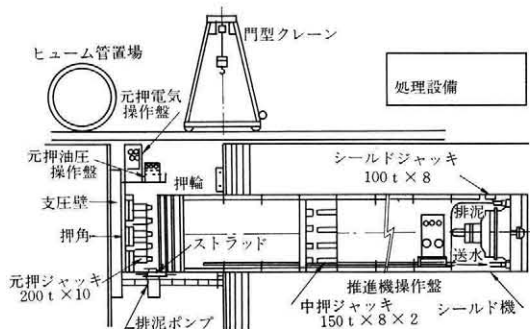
I D3,000 × t 250H P 泥水加圧推進工法図
